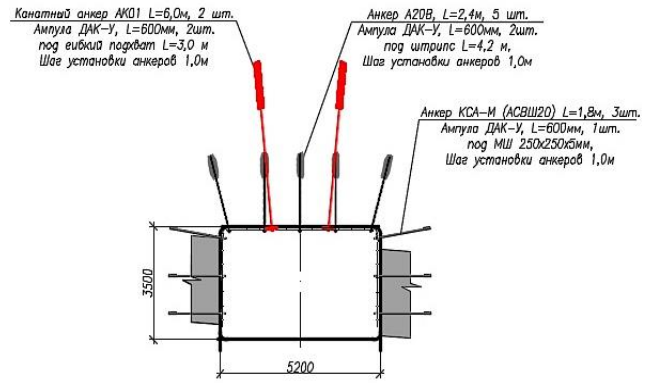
Схема крепления вентиляционного штрека шахты «Увальная»
